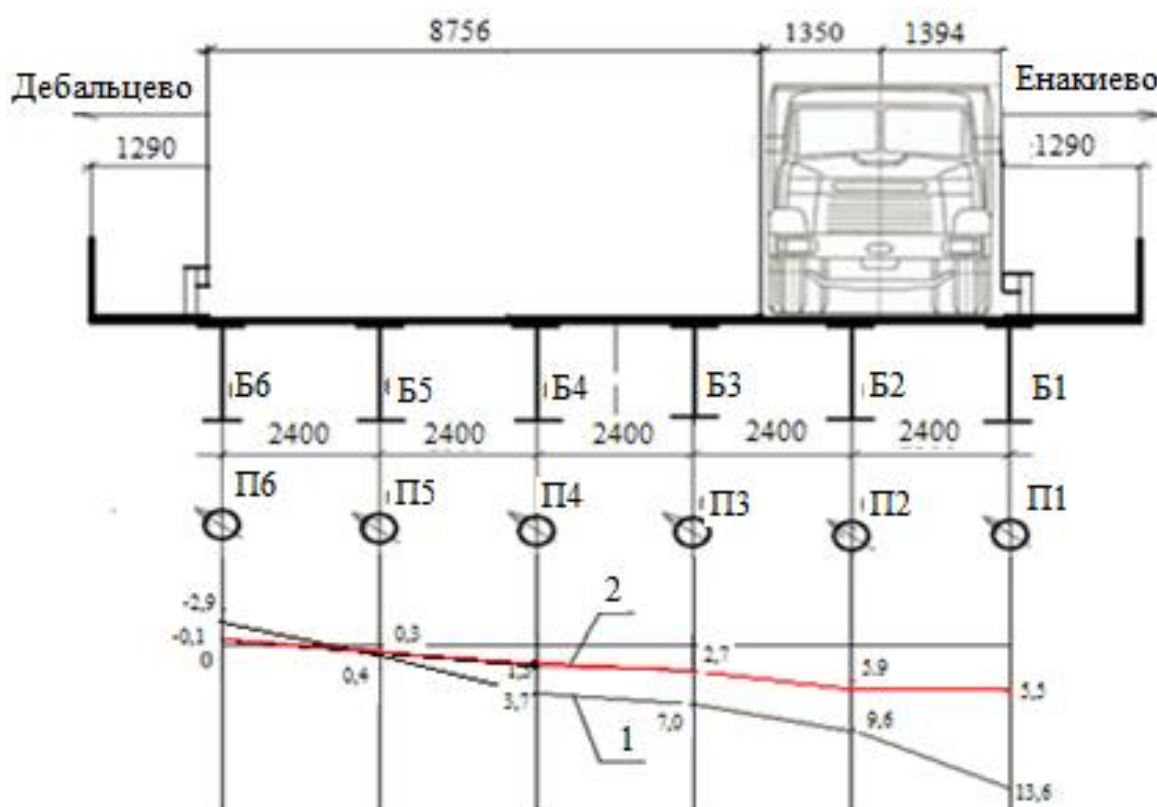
Установки испытательной нагрузки по схемам 2 и 4
